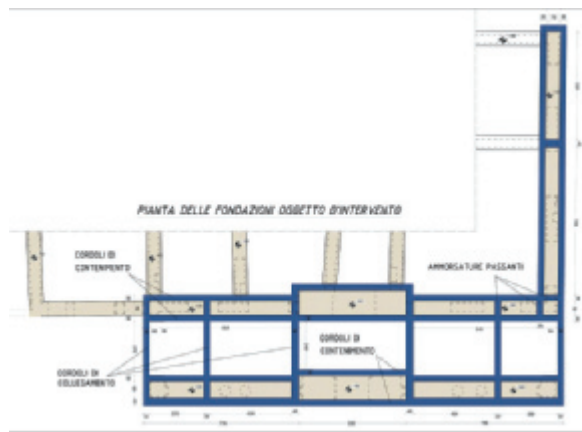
Schema planimetrico della proposta d'intervento per le fondazioni sedi di cedimenti del terreno.
